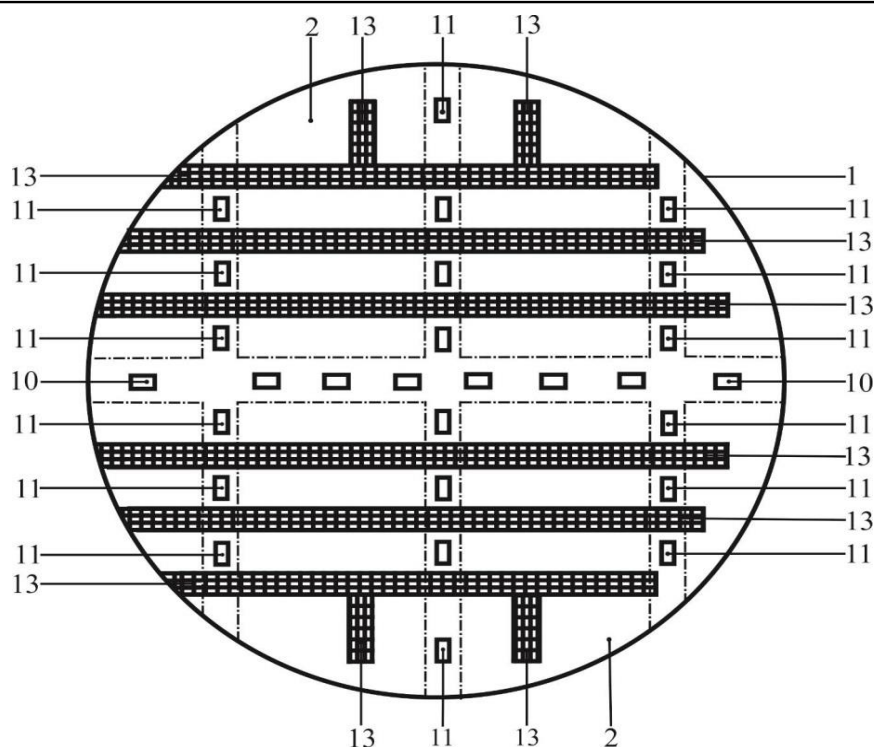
Фундамент цилиндрического бункера для хранения сельскохозяйственной продукции: вид сверху
